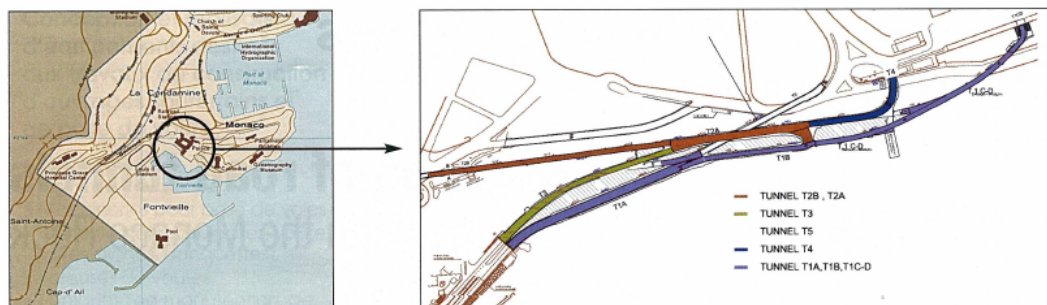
Vue en plan des tunnels sous le Rocher / Plan view of tunnels beneath the Rock.
